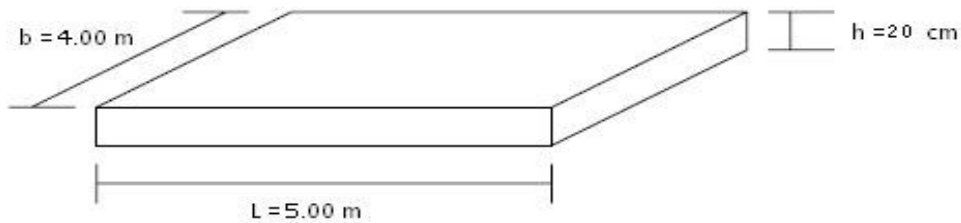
Esquema gráfico de las dimensiones de losa para el pavimento de concreto de arena
